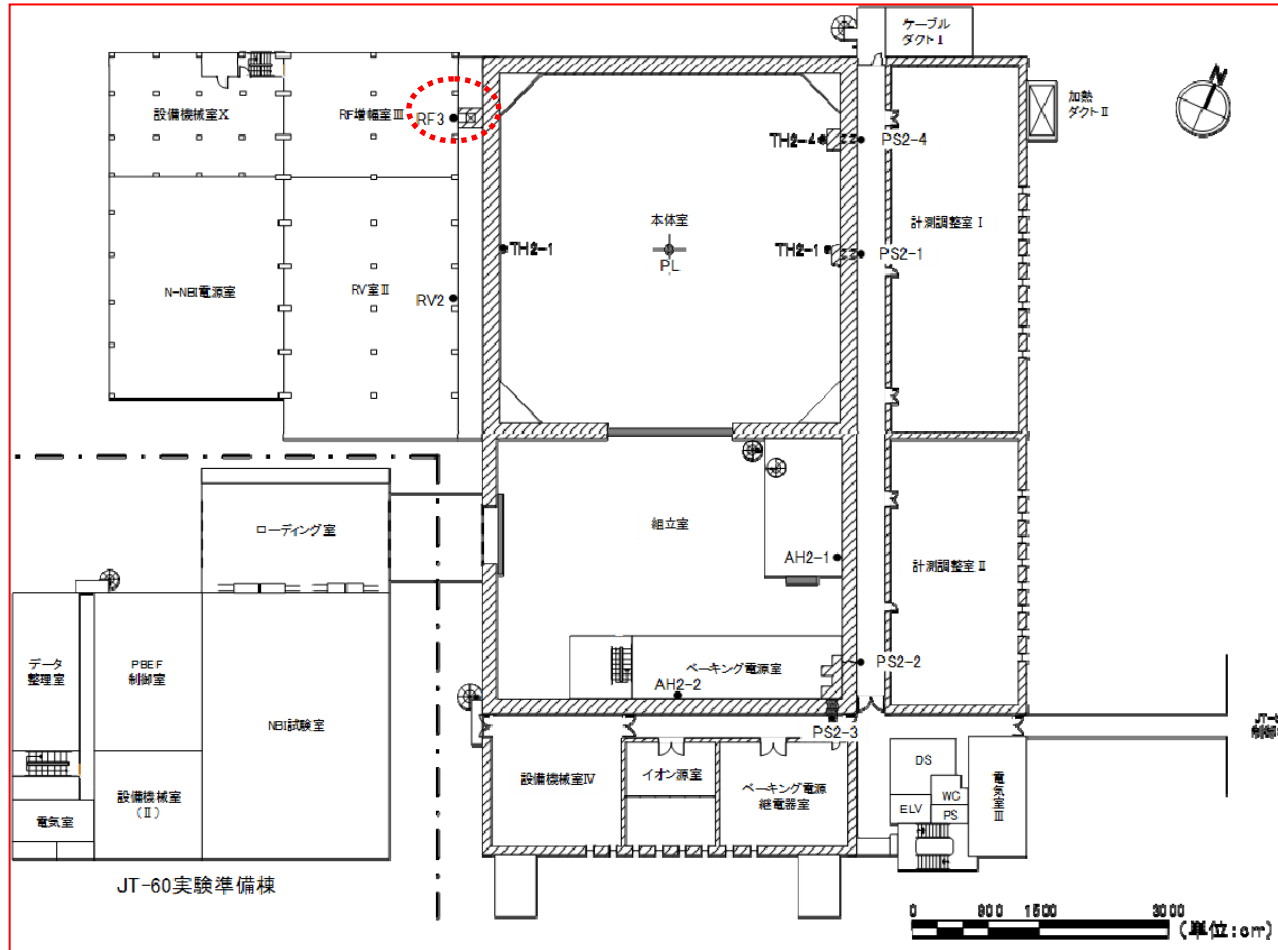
1. 5. 2 JT-60実験棟2階平面図 (単位: cm) (改修後)
